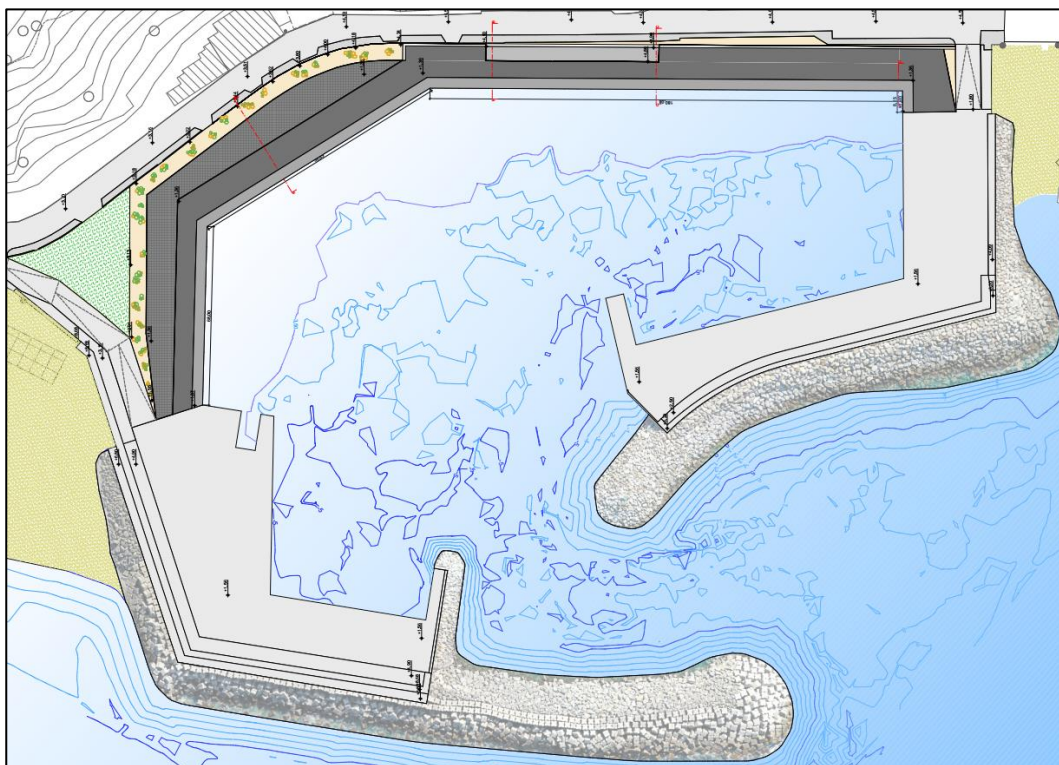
Planimetria di progetto – Area di intervento P.D. (Elaborato A.11)
